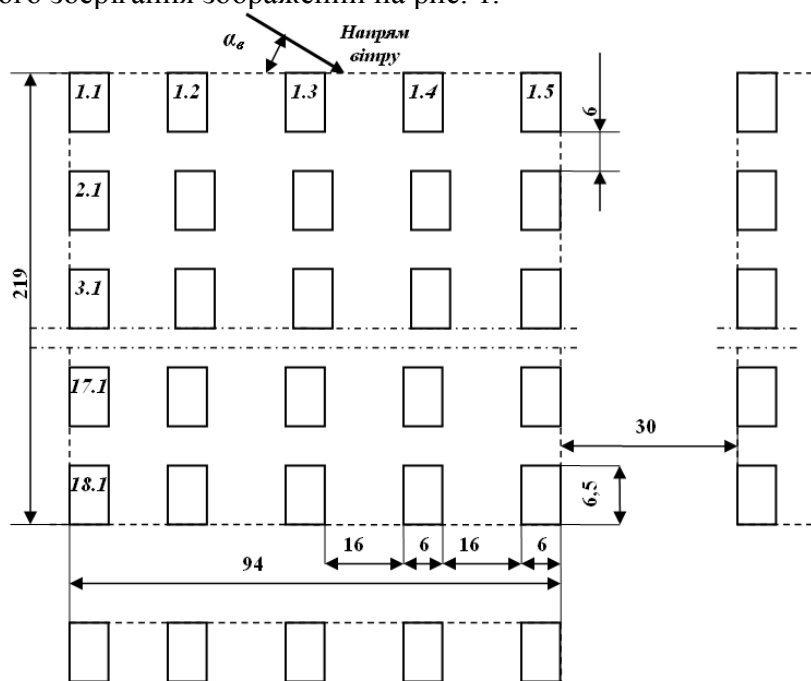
План кварталу складу круглих лісоматеріалів штабельного зберігання
